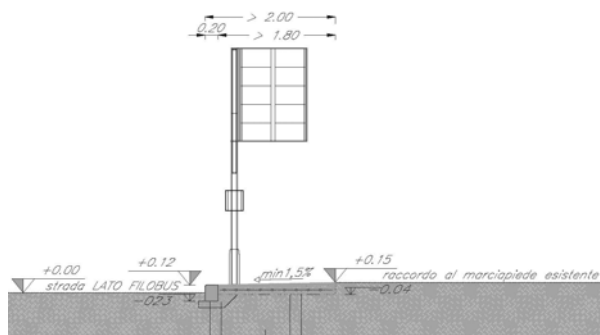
Sezione trasversale tipo banchina T4 (L=2 m)
